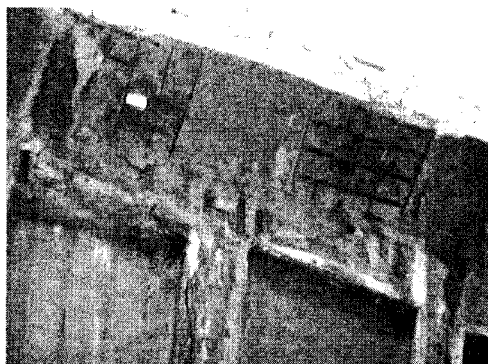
Корозія арматури і руйнування бетону верхнього пояса жорсткості градирні № 4 на Дарницькій ТЕЦ, захисний шар бетону нижче від проектного
